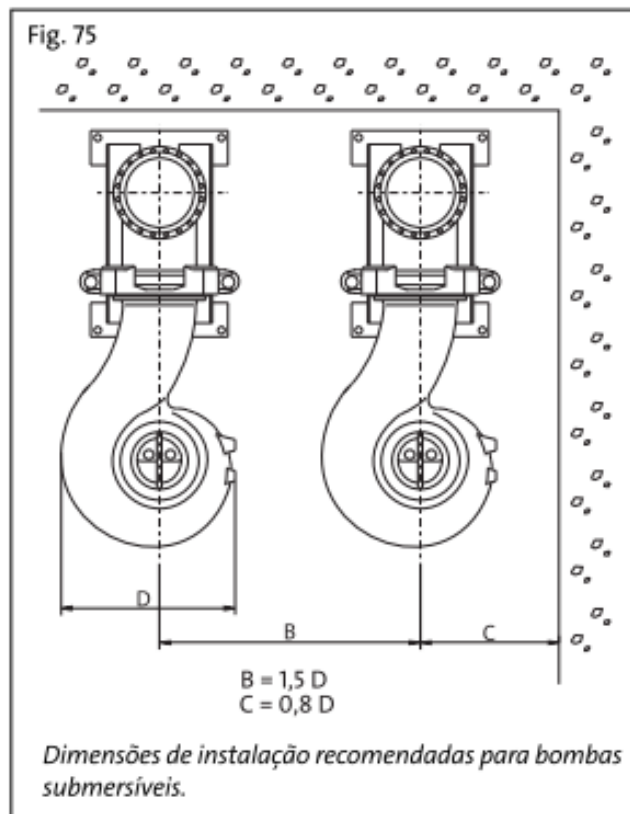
Dimensões mínimas de um poço de bombagem de pequenas dimensões [20]
